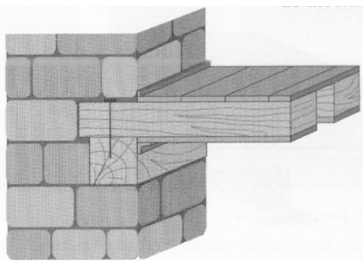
Pavimento ligado ao frechal (Appleton, 2003).
